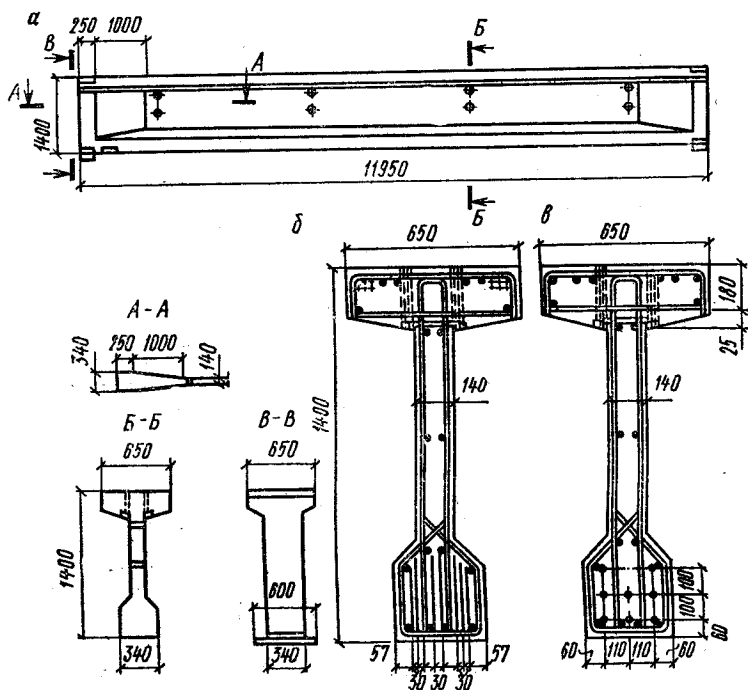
Конструкция предварительно напряженной подкрановой балки пролетом 12 м
